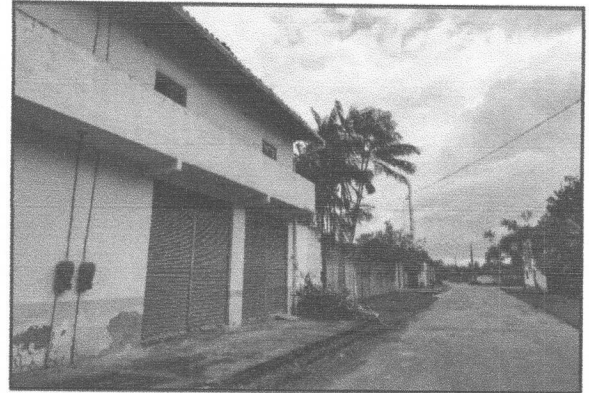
Imagem da rua de acesso ao imóvel com pavimentação asfáltica
